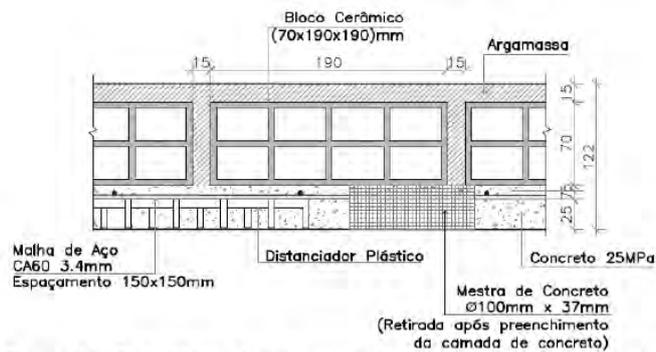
Corte típico dos painéis pré-moldados (medidas em mm).
